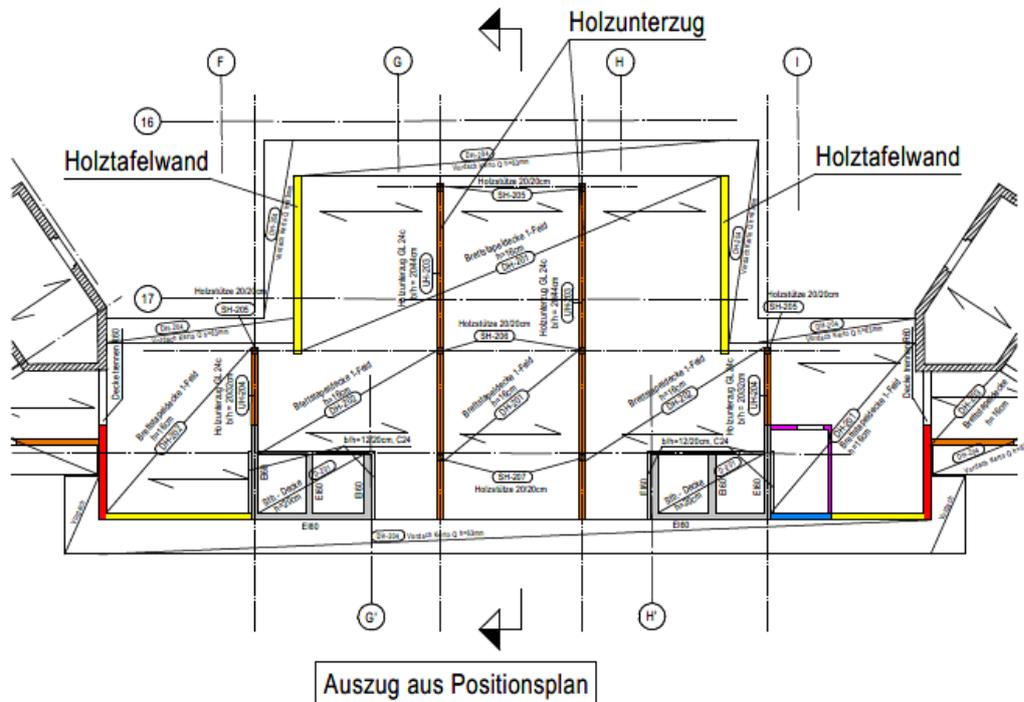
Grundriss Mitteltrakt [Walter Reif Ingenieurgesellschaft mbH]
